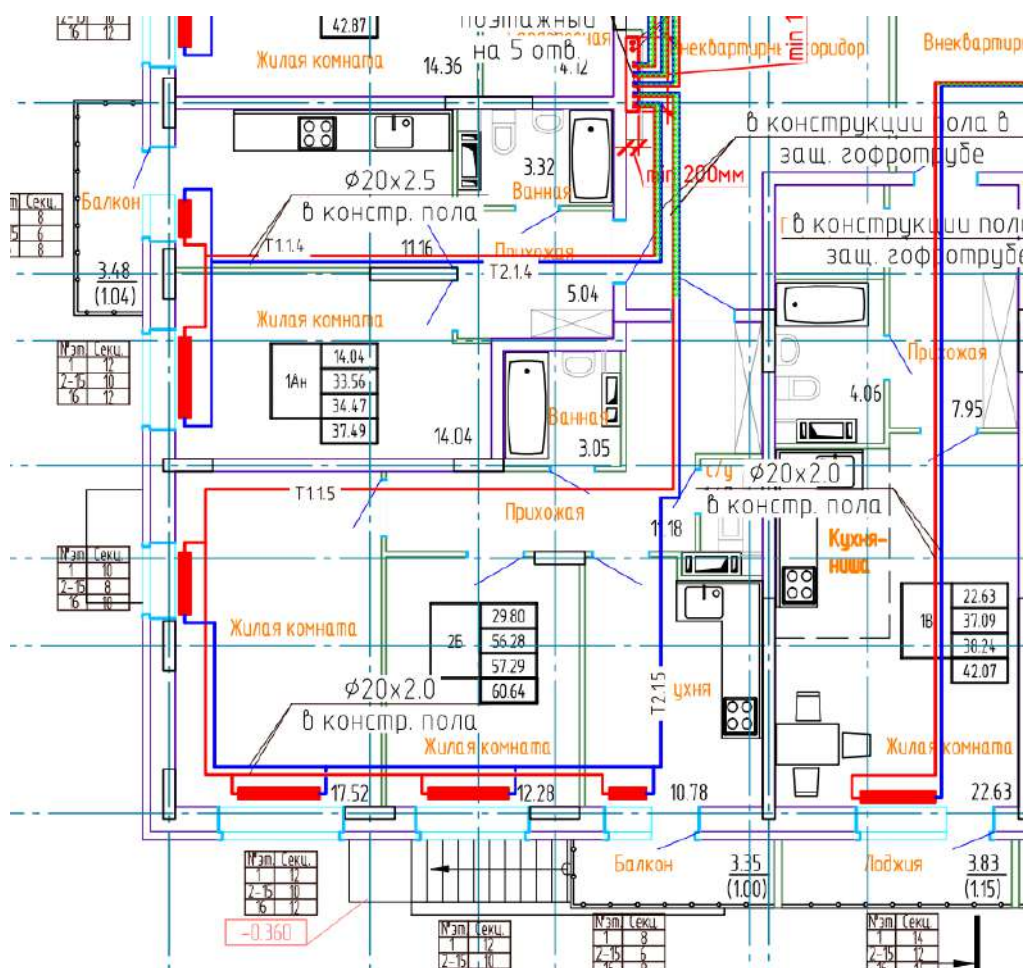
Однотрубная горизонтальная попутная схема системы отопления без индивидуального квартирного теплового пункта.
